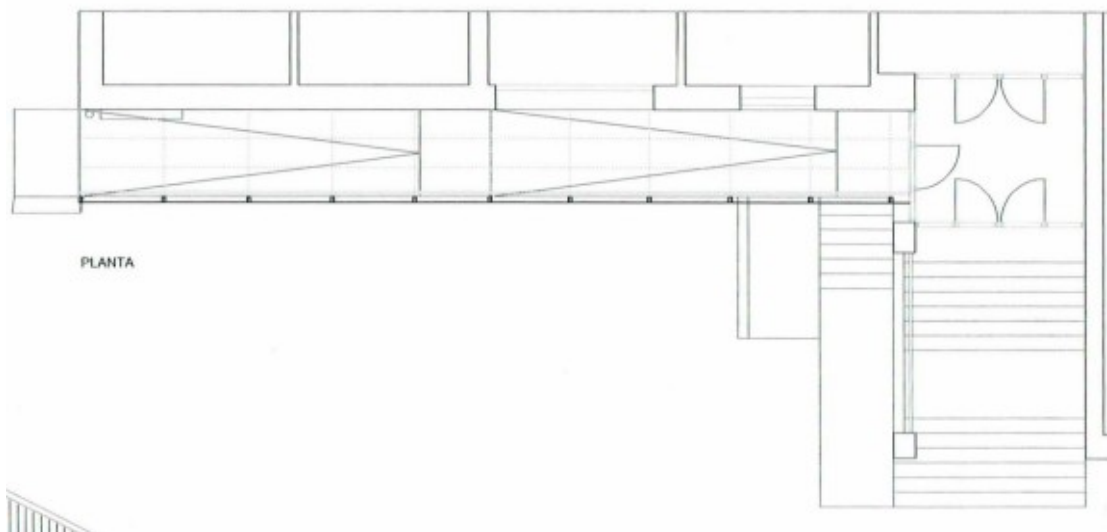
Acceso a edificio y detalles rampa accesibilidad.
